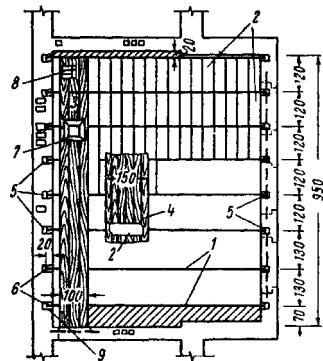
Схема организации работ по монтажу участка междуэтажного перекрытия
